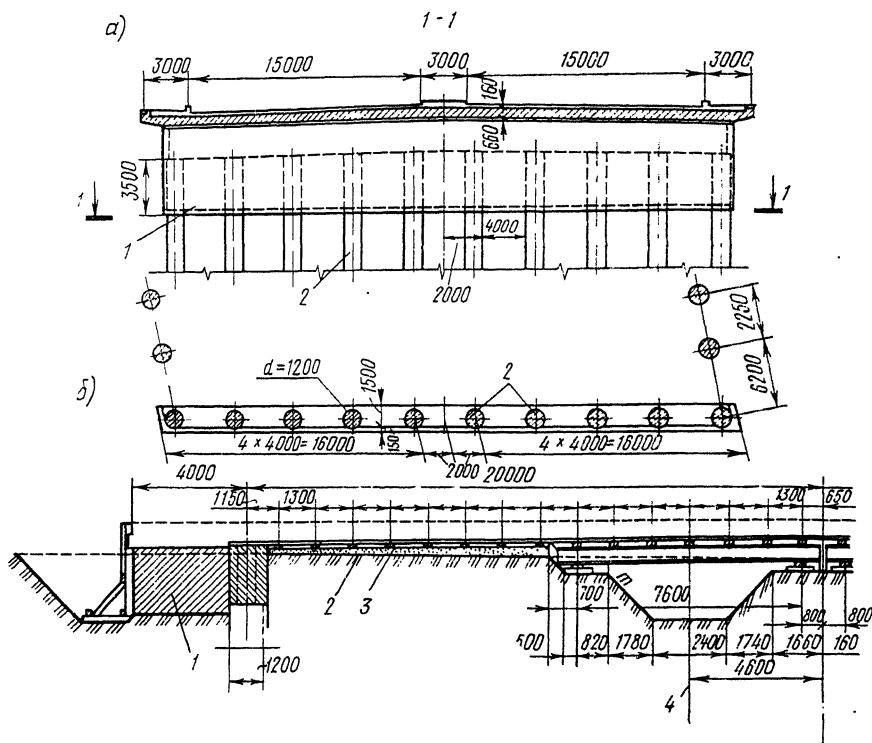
Строительство путепровода с бетонированием безбалочного пролетного строения по грунту
